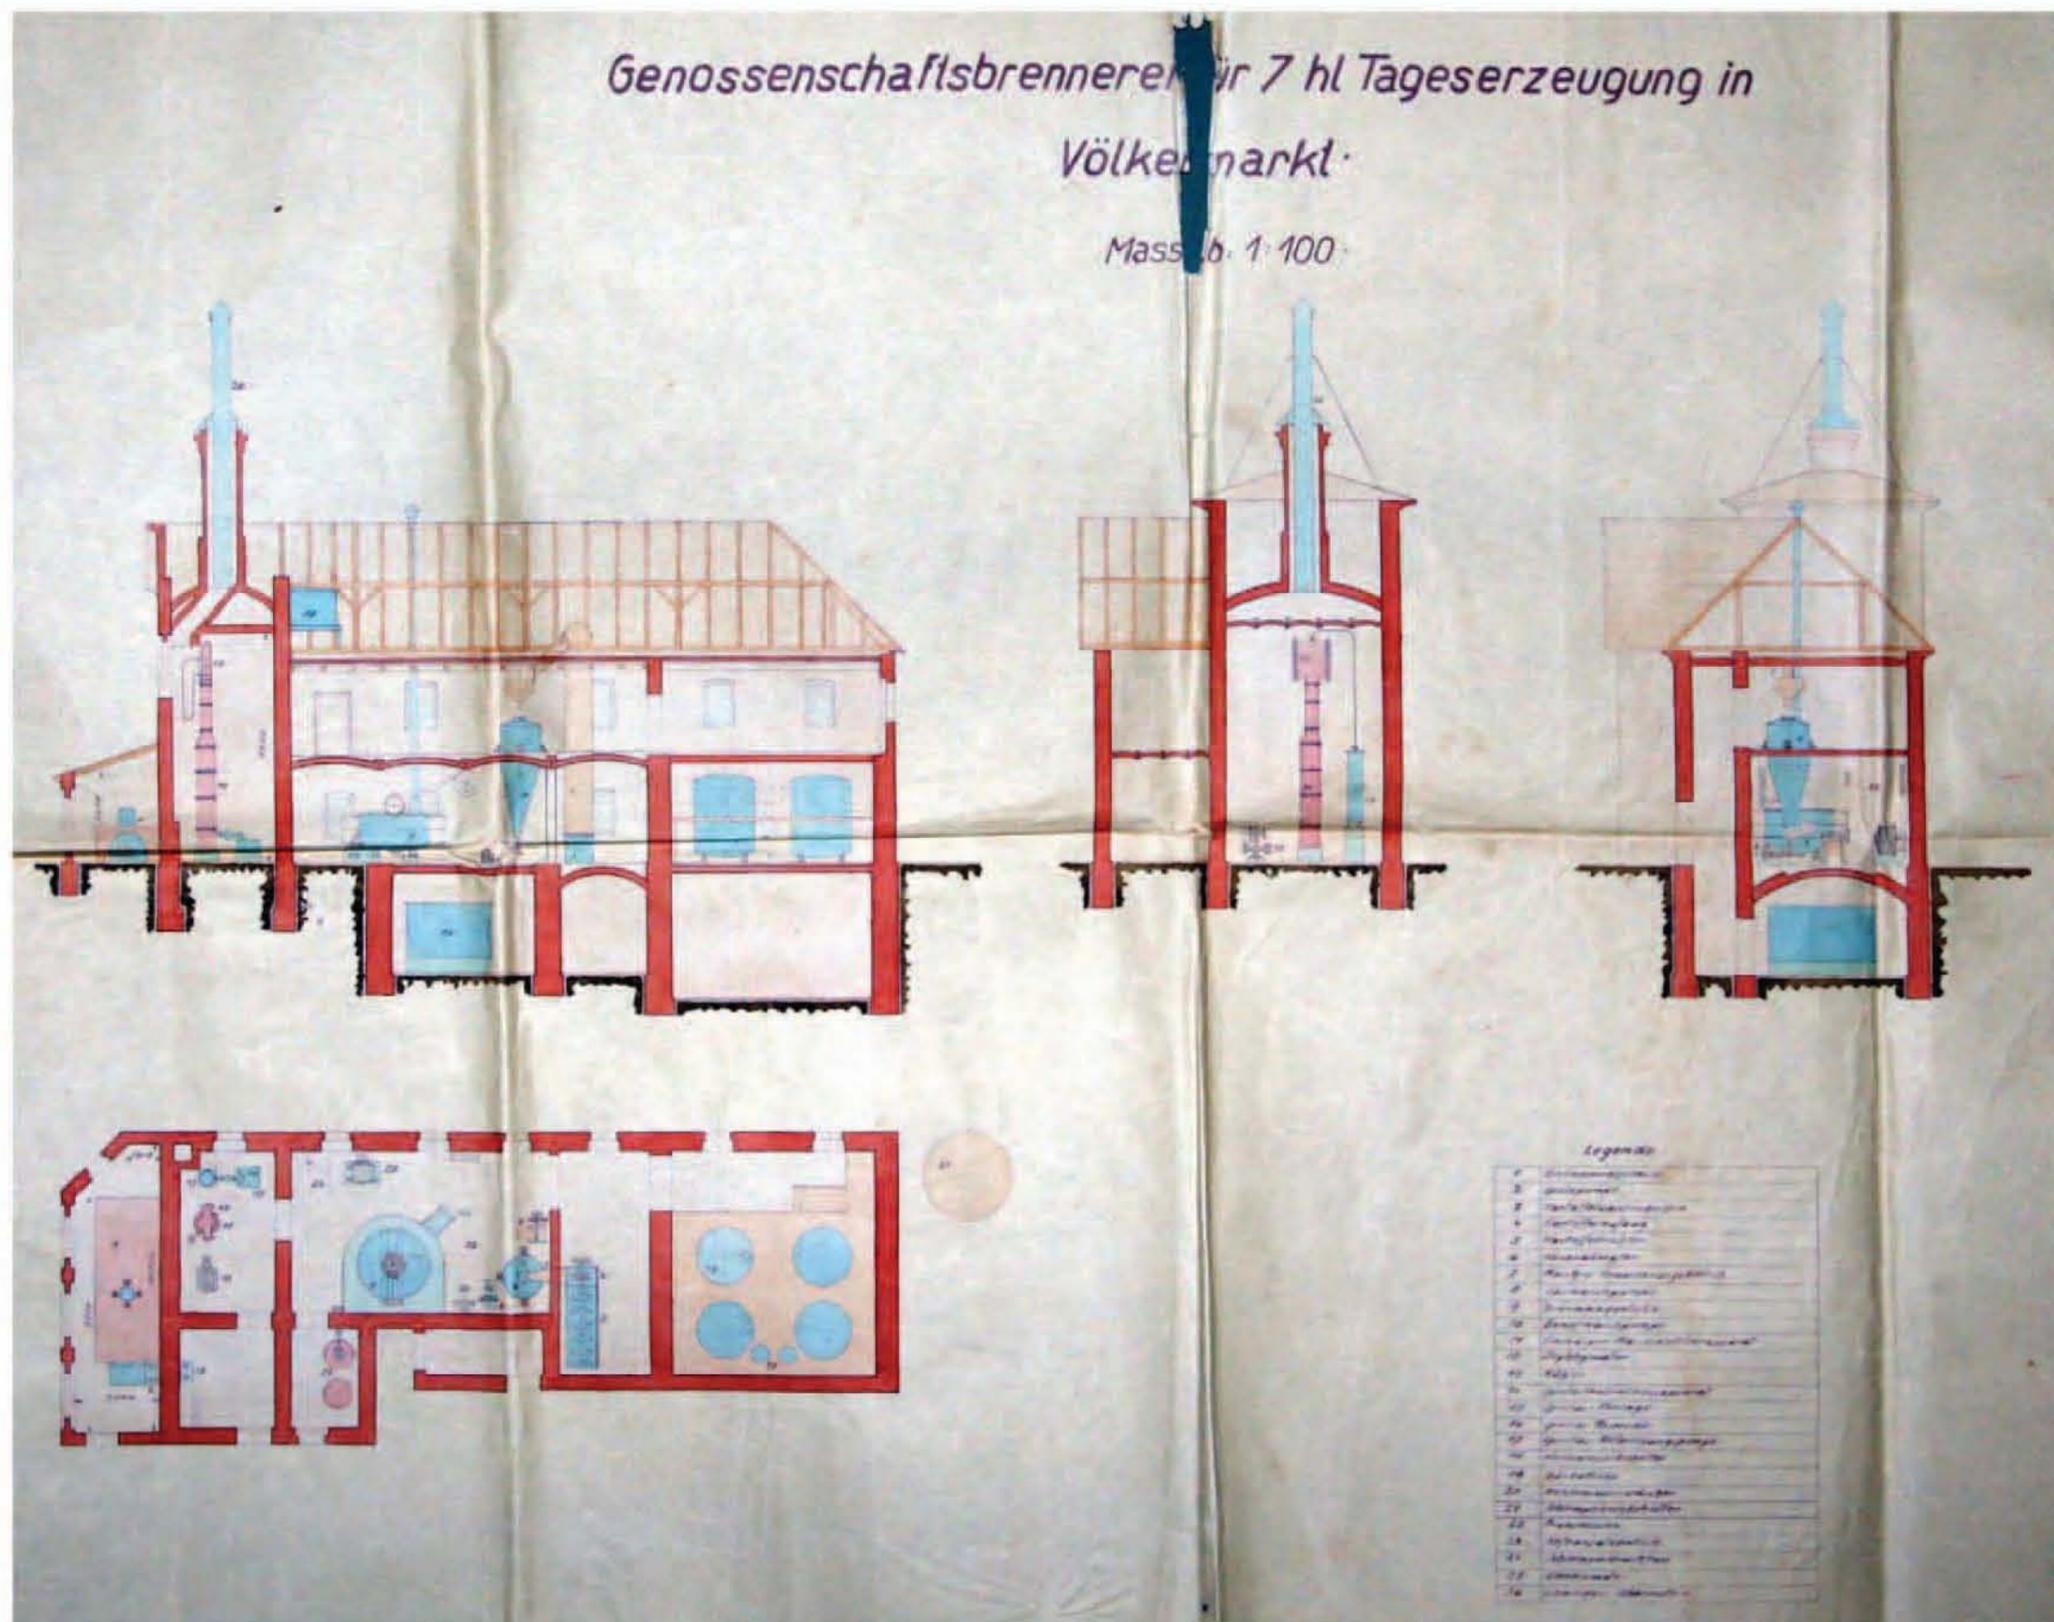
Ausstattung und Anordnung der technischen Geräte in der Brauerei
